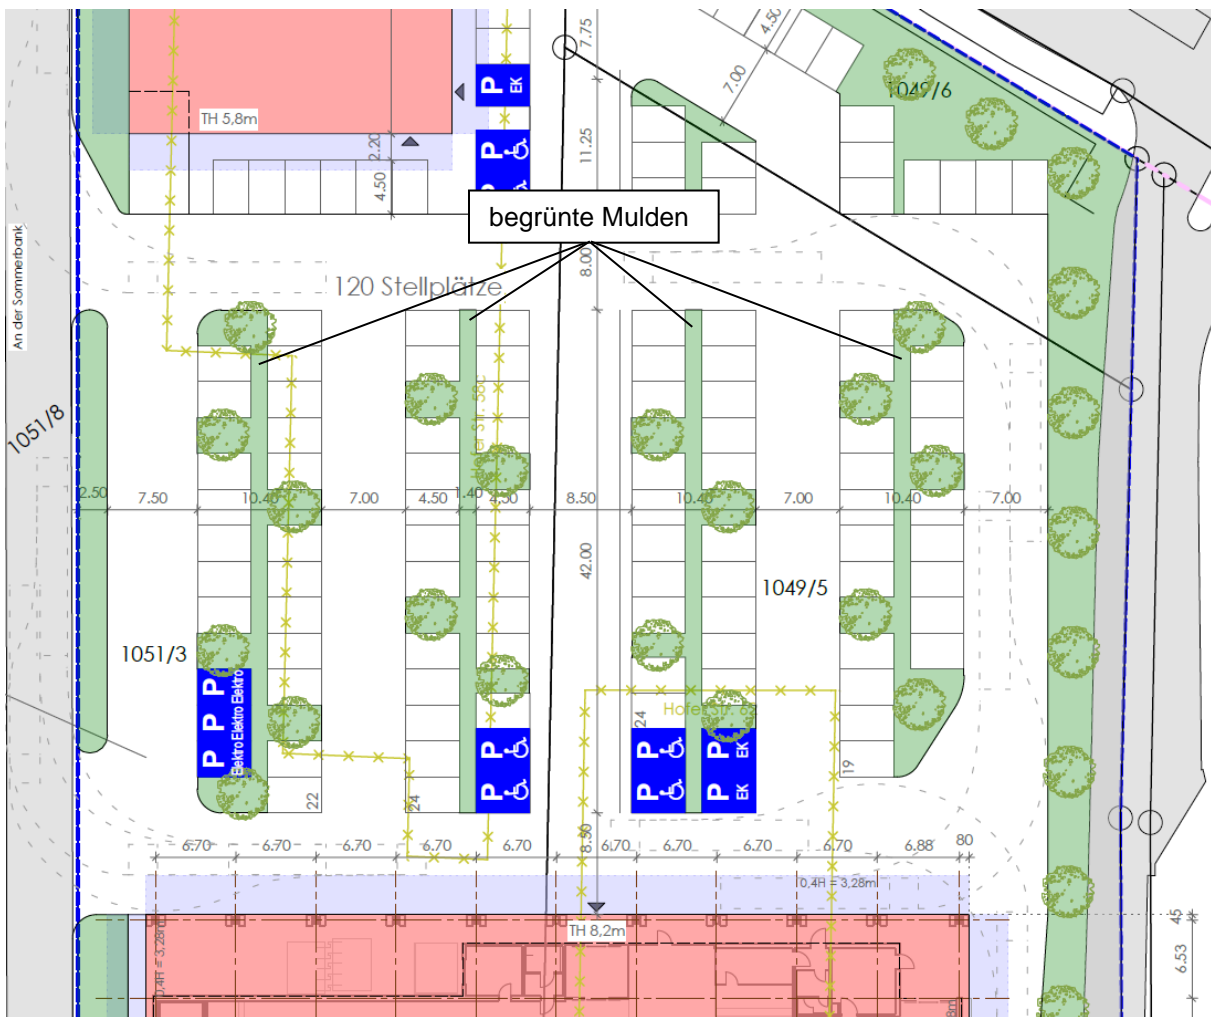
Lageplan der Objektplanung (Ausschnitt),
